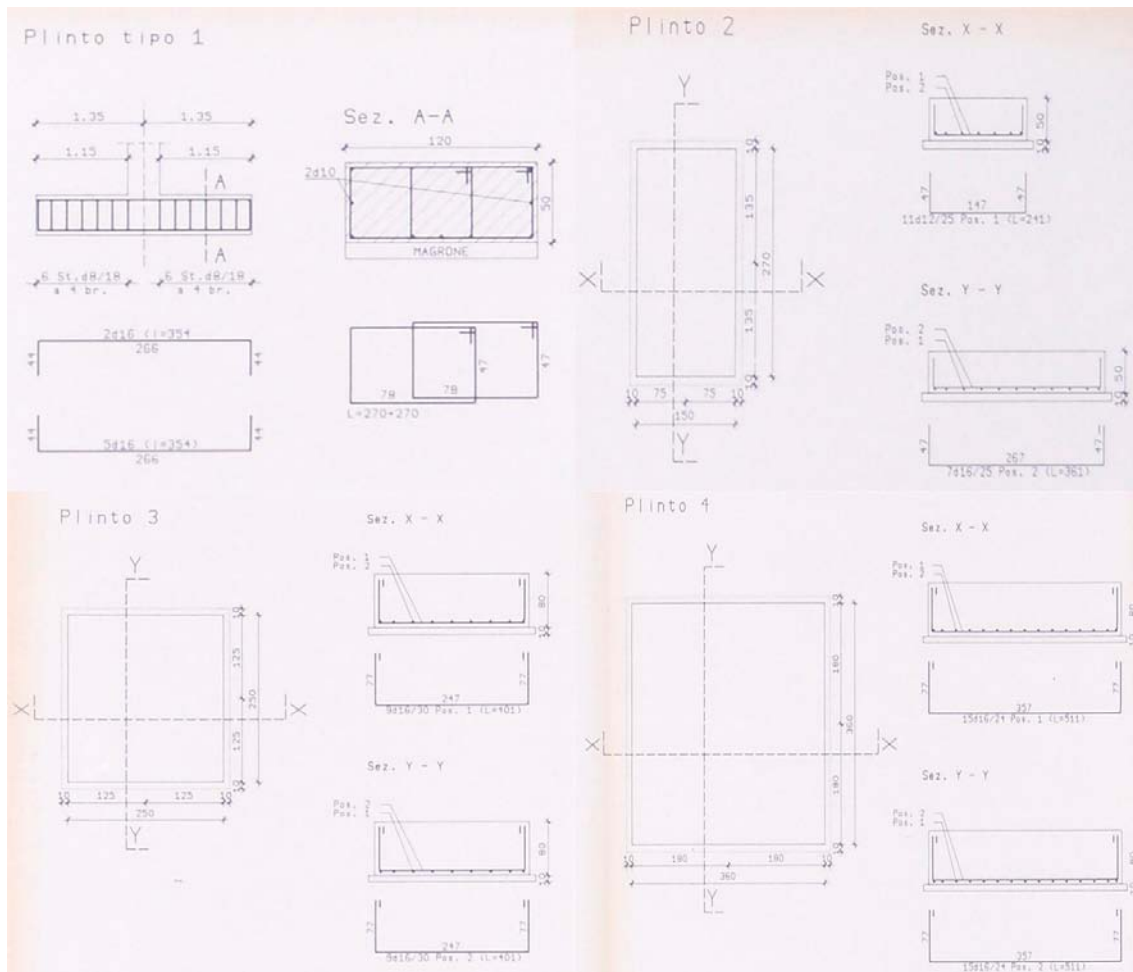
Particolare di A.1996.cap.sa.T02 - Strutture di fondazione e pilastri eseguiti in opera - Tipologie plinti
